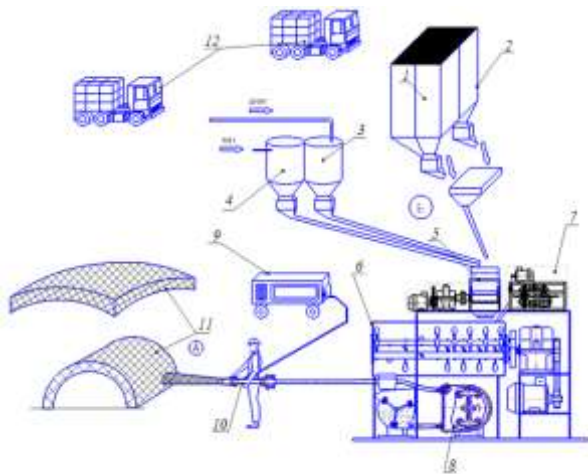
Технологическая схема изготовления железобетонных конструкций неправильной геометрической формы способом мокрого торкретирования непосредственно на строительной площадке.
